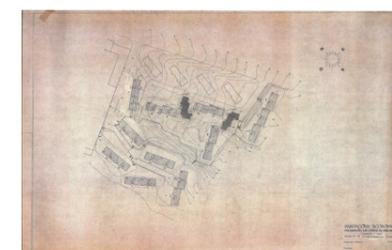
| Planta de implantação – Conjunto de 168 habitações no Barreiro.
